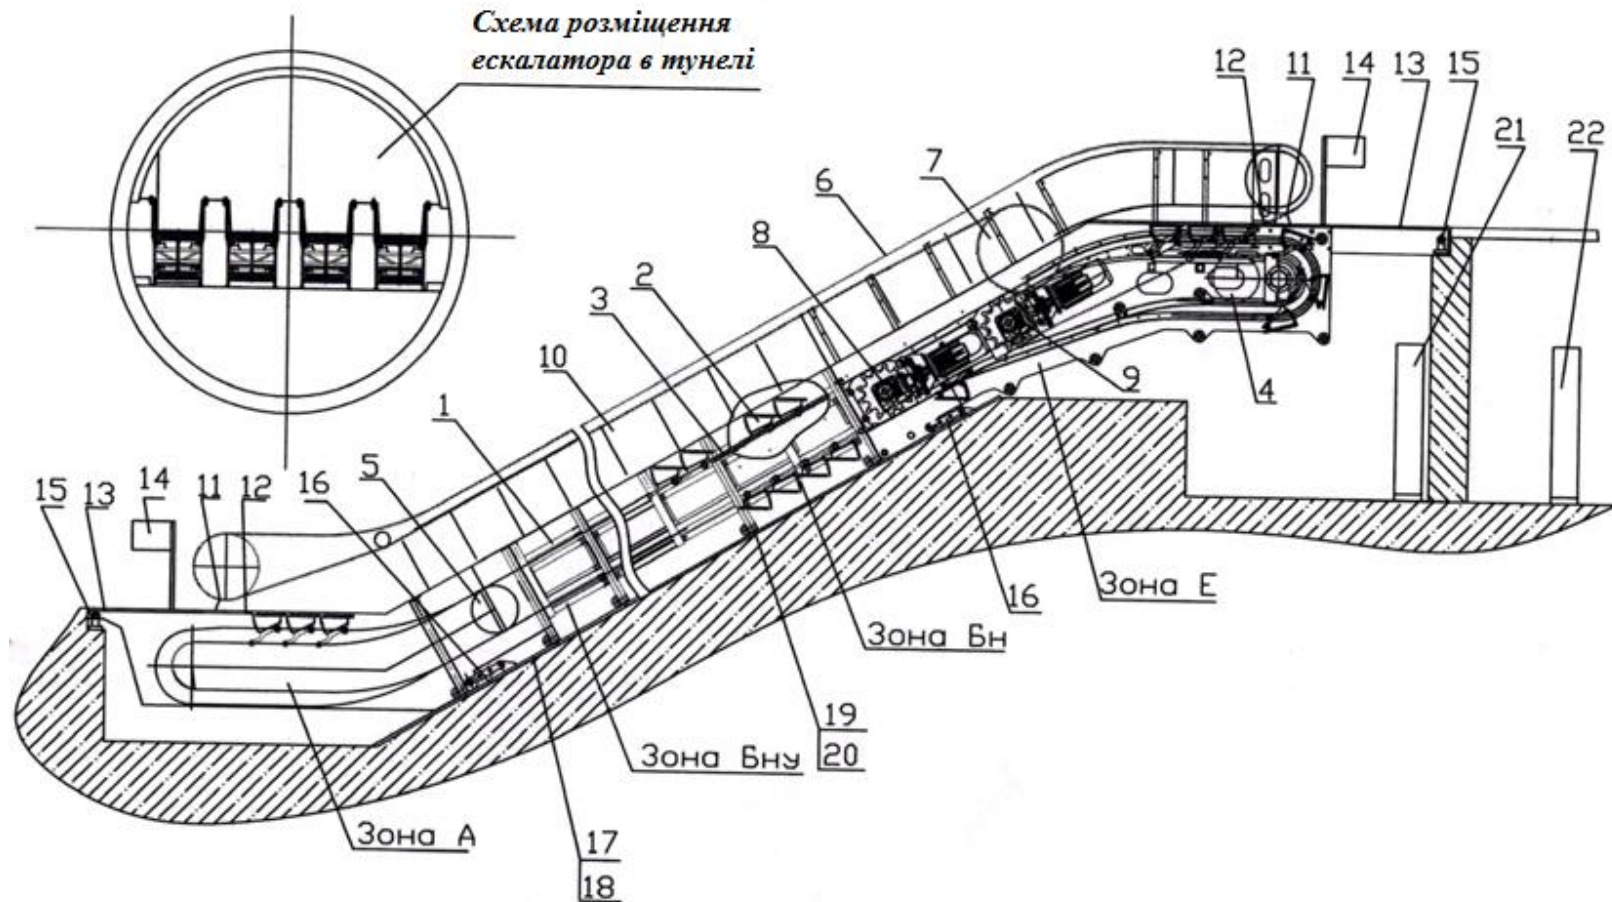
Основні складові частини ескалятора ЕТХ: 1 – несуча металоконструкція з напрямними сходового полотна; 2 – сходинка; 3 – тягові ланцюги; 4 – верхній натяжний пристрій; 5 – нижній натяжний пристрій; 6 – поручень; 7 – натяжний пристрій поручня; 8 – модуль привода сходового полотна (нижній основний); 9 – модуль привода сходового полотна і поручнів (верхній додатковий); 10 – балюстрада; 11 – гирло поручня; 12 – вхідна площадка з гребнями; 13 – плити перекриття; 14 – перекивач; 15 – віброопора; 16 – реактивна тяга; 17 – напрямний швелер; 18 – анкери; 19 – регулююча опора; 20 – фіксатор зон; 21 – шафи керування і пульт оператора; 22 – шафа автоматичного введення резерву
